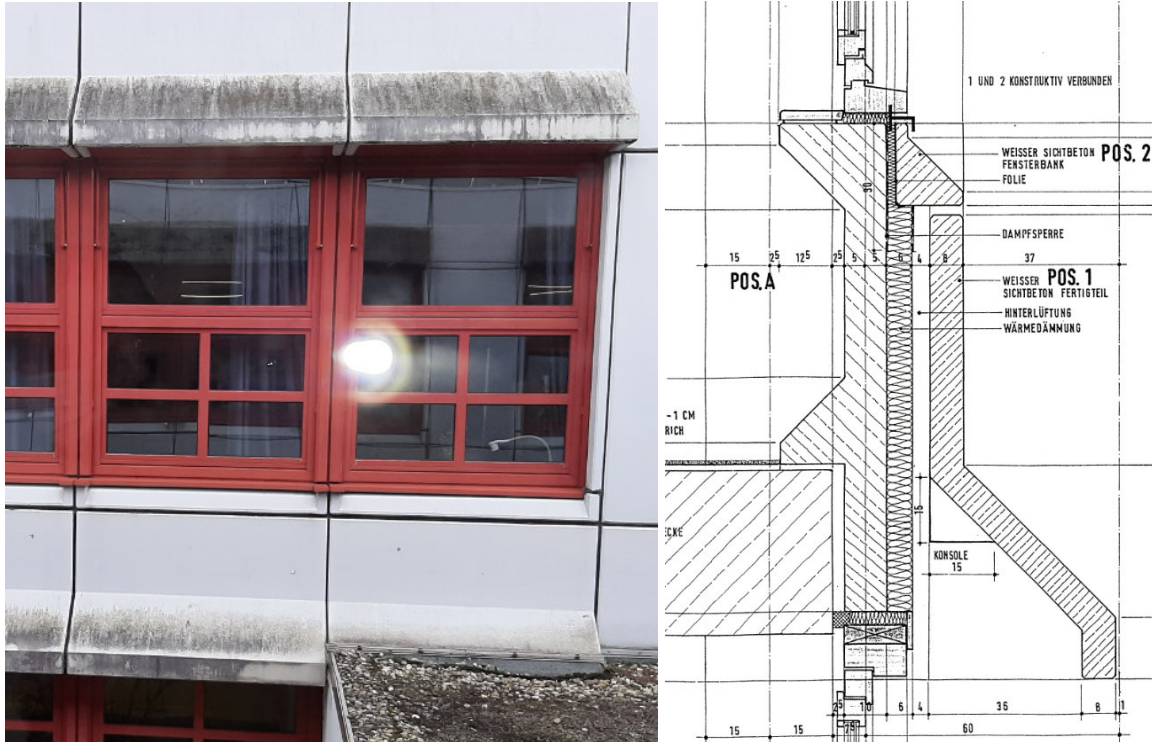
Foto v. Ortstermin (16.03.2021); Fassadenschnitt Bestand (Vertikal)
